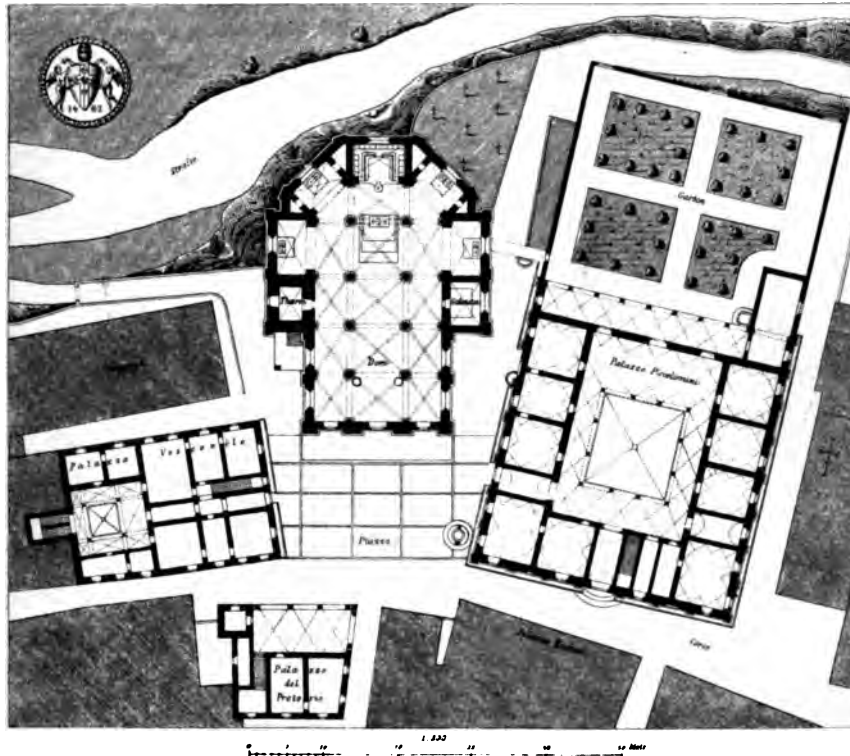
Dom und Paläste in Pienza. Grundriss. (Nach Mayreder.)
